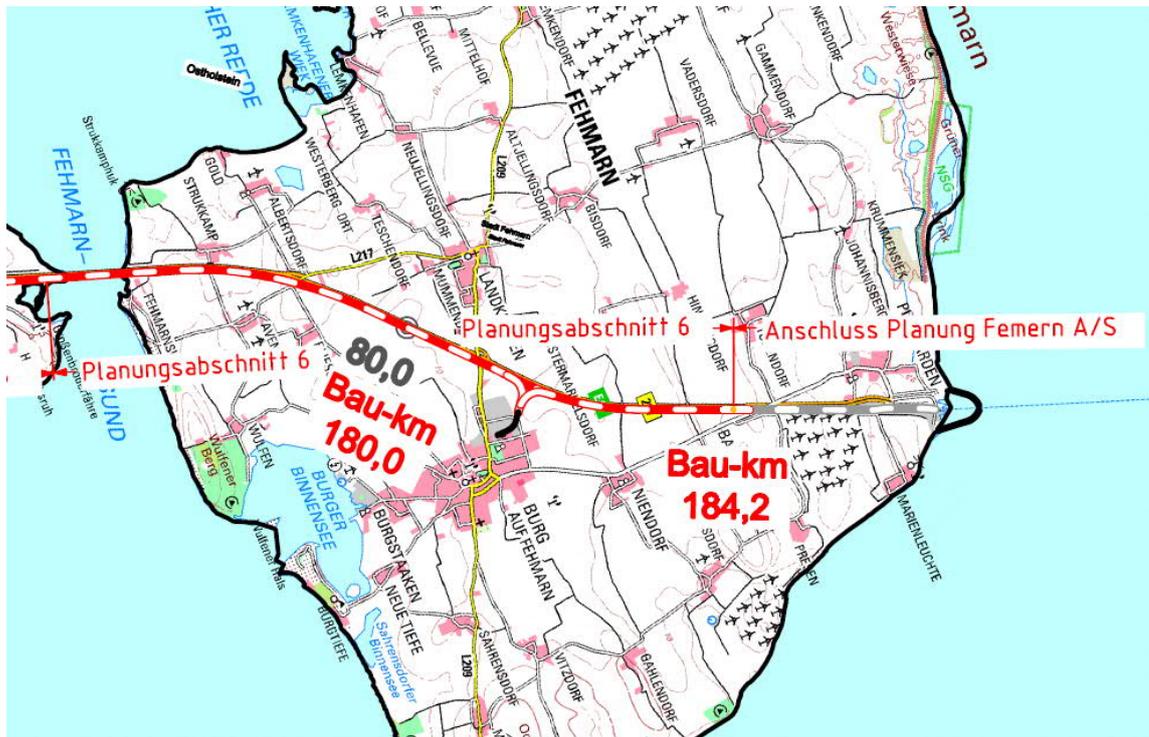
Übersicht Planfeststellungsabschnitt 6
